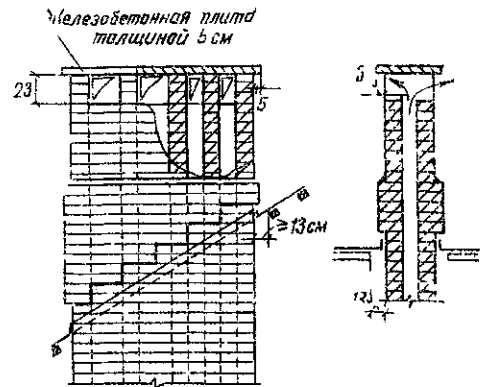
16 Схема дымовых каналов, перекрытых железобетонной плитой
